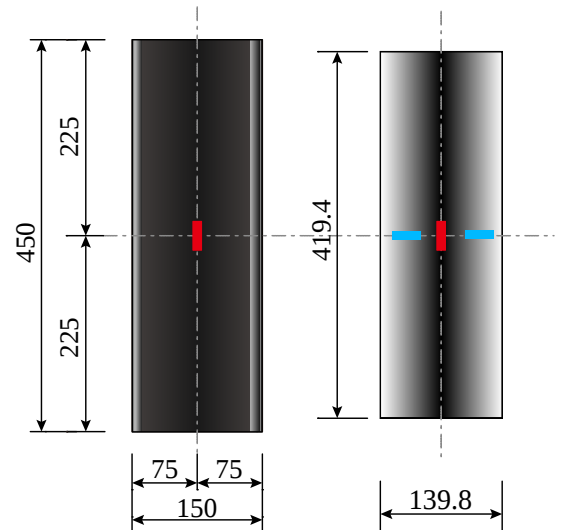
試験体形状，変位計およびひずみゲージ貼付位置
